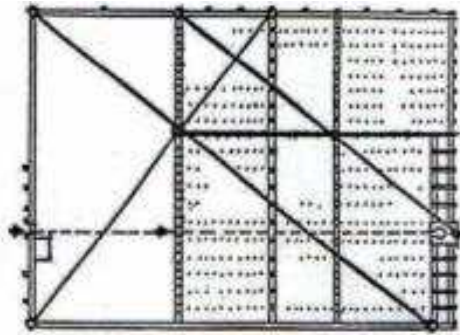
Planta de la mezquita (Hoz Arderius)
